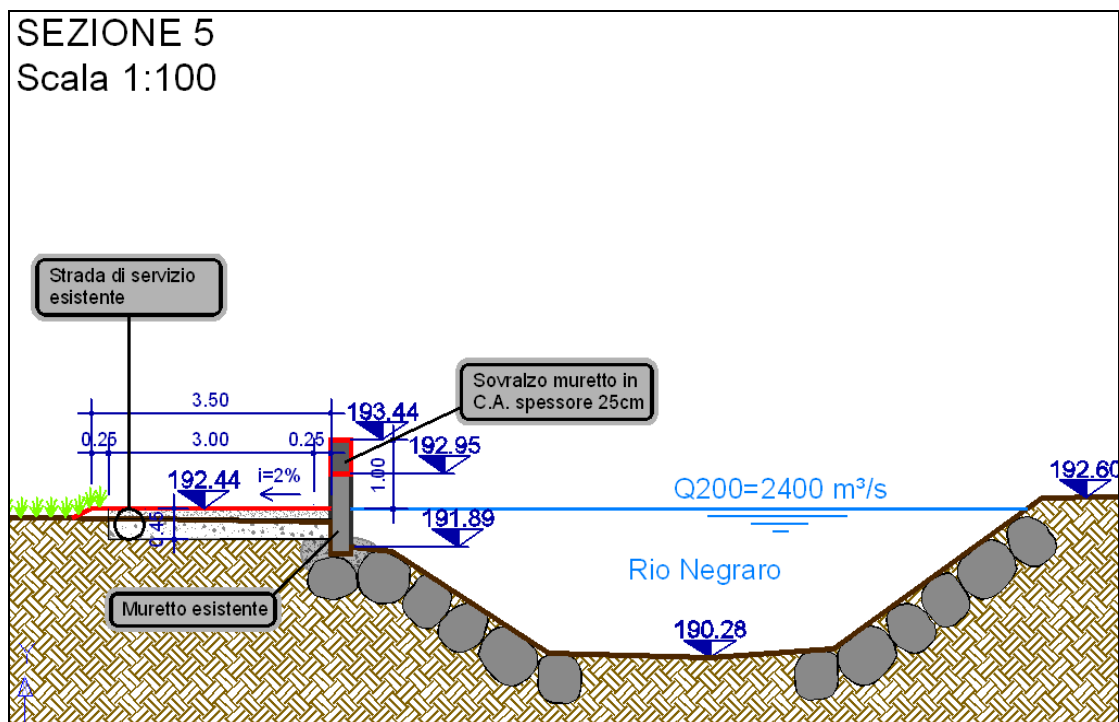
SEZIONE TIPOLOGICA PRESIDIO ARGINALE CON SOVRALZO MURETTO
